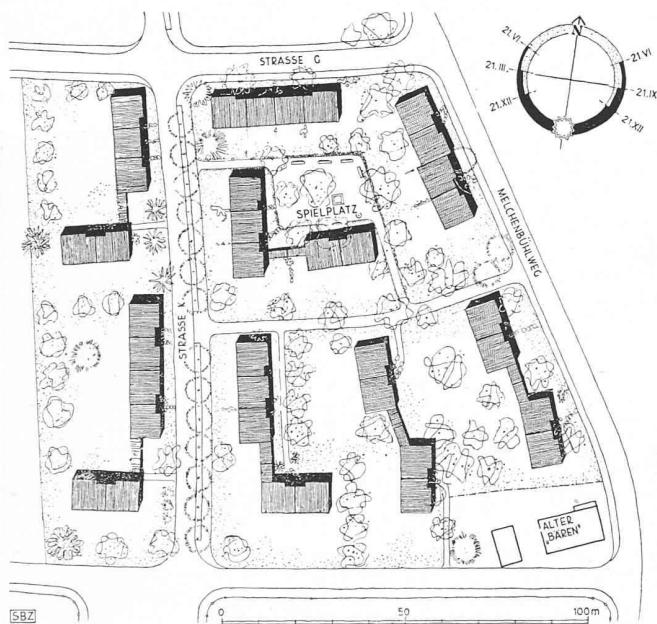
Siedlung Melchenbühl in Bern; Lageplan 1 : 2000.
